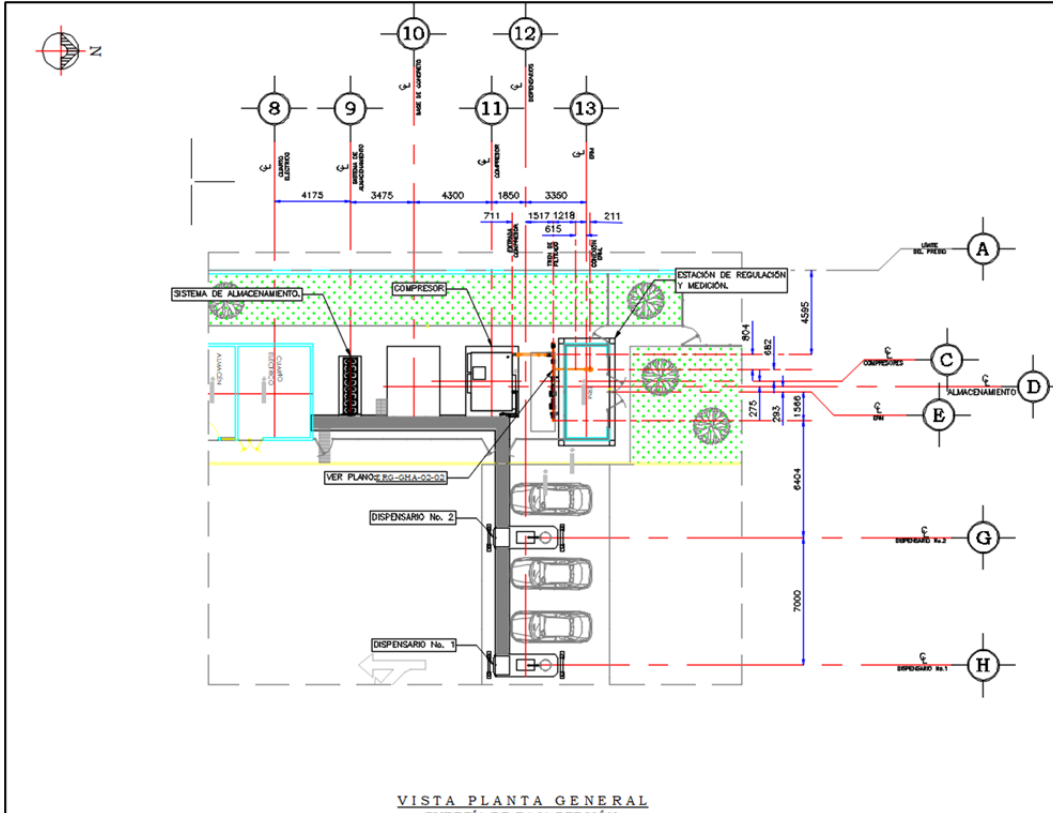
Planta General de Arreglo Para Tubería de Baja Presión.
